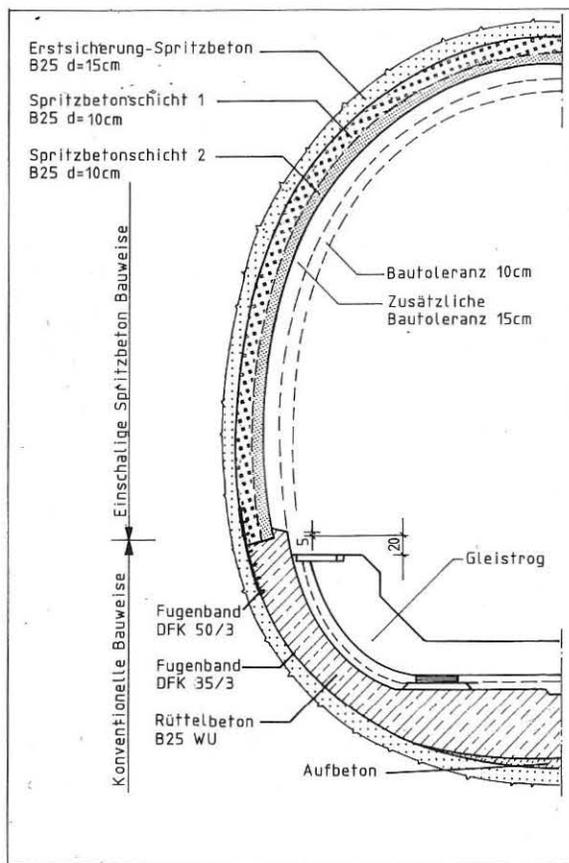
Aufbau der "Einschaligen Spritzbetonauskleidung" für eine Teststrecke
